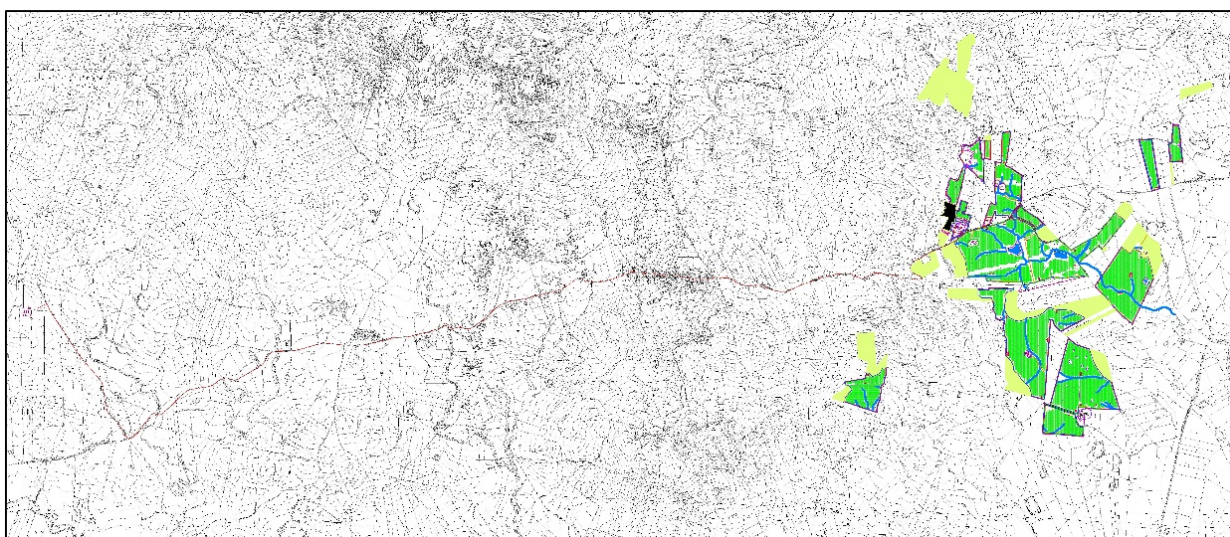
Area dell'Impianto con il tracciato del cavidotto di collegamento alla futura S.S.E..TERNA
